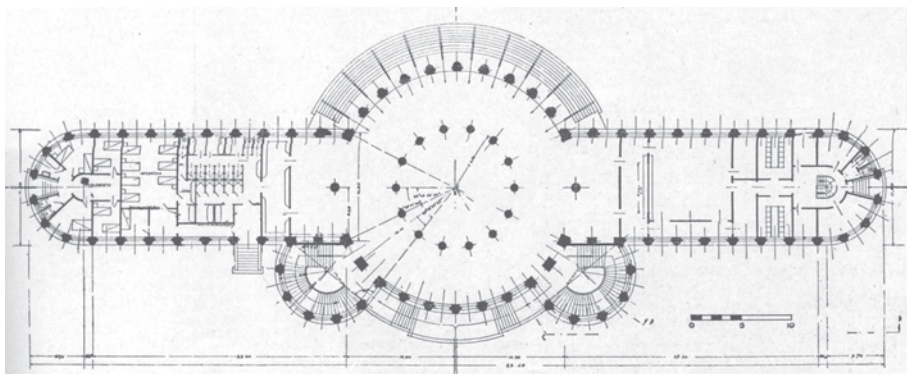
Fiat-Ferienkolonie „Torre Balilla“: Grundriss EG
